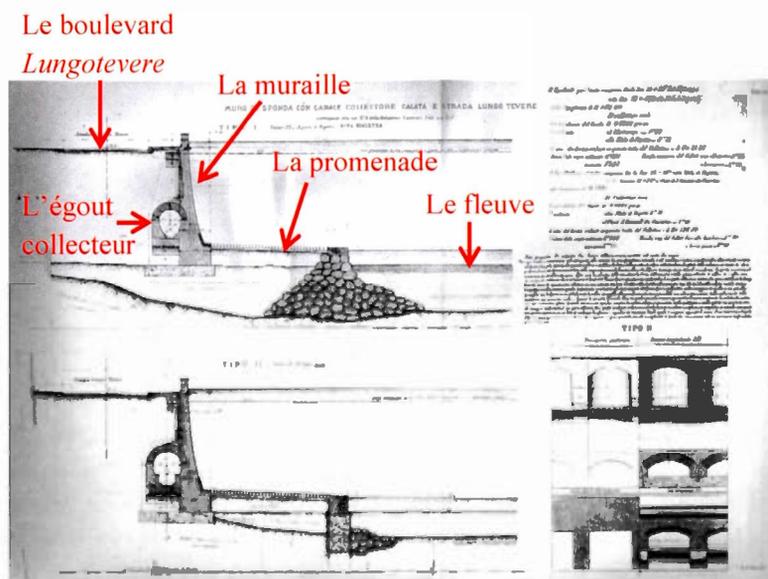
Coupe illustrant le projet de construction des murailles de protection construites de 1870 à 1920
